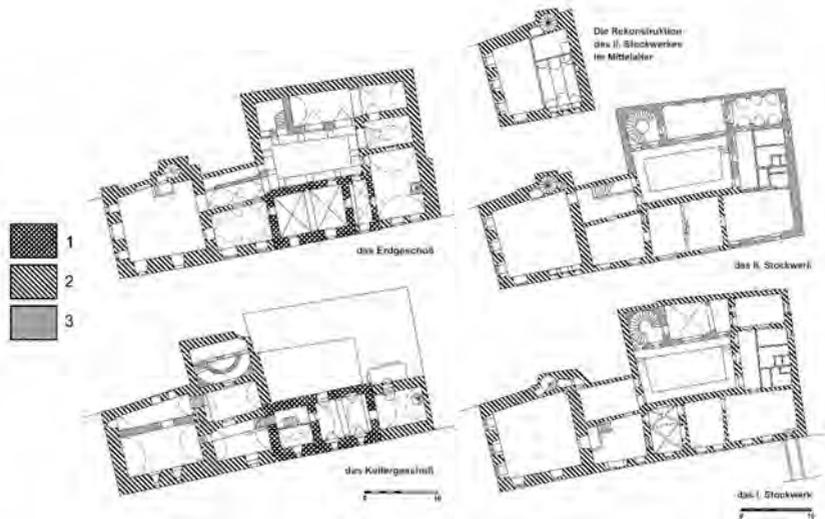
Prag, Haus Zur Steinernen Glocke (dům U kamenného zvonu), Grundriss: 1) gotisches Mauerwerk aus dem 13. Jh. – 2) gotisches Mauerwerk aus dem 14. Jh. – 3) das Mauerwerk aus dem 18. Jh.
